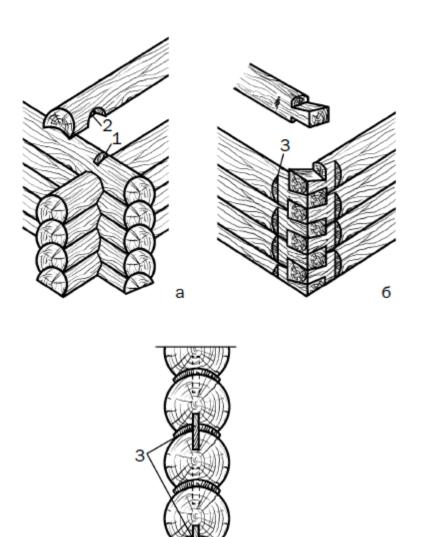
Выполнение углом сруба: а - «в обло»; б - «в лапу»; в - закрепление венцов шипами; 1 - гнездо; 2 - потайной шип; 3 - коренной шип
